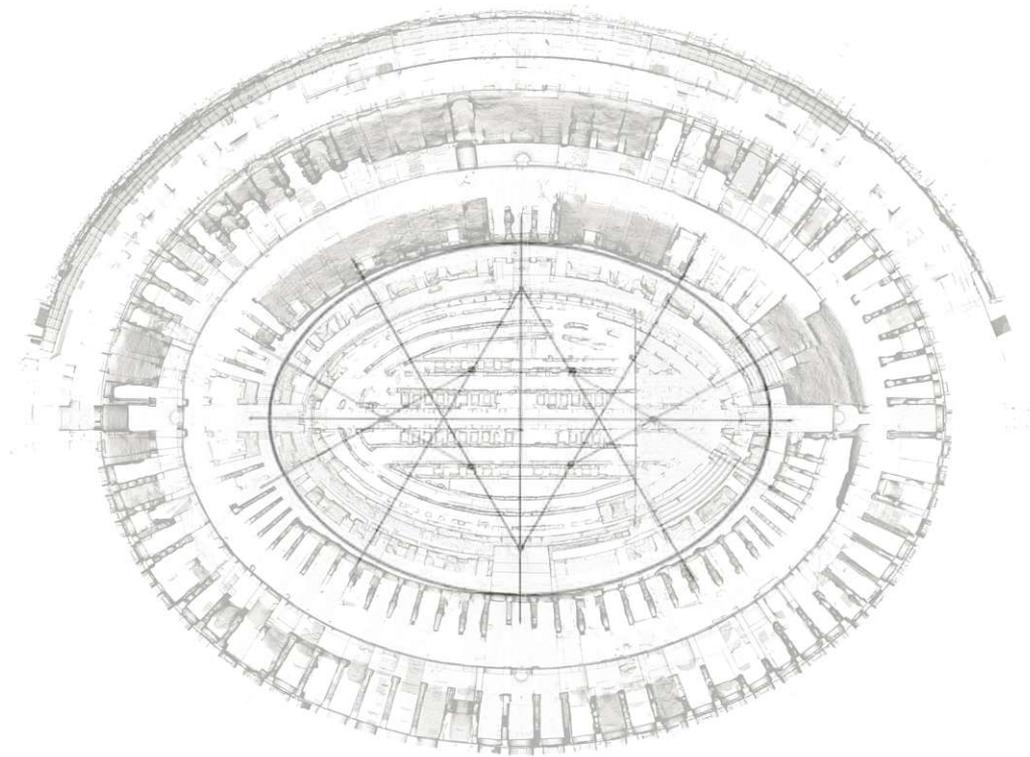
Überlagerung von Mark Wilson Jones' Achtpunkteoval und dem tatsächlichen Grundriss des Kolosseums
